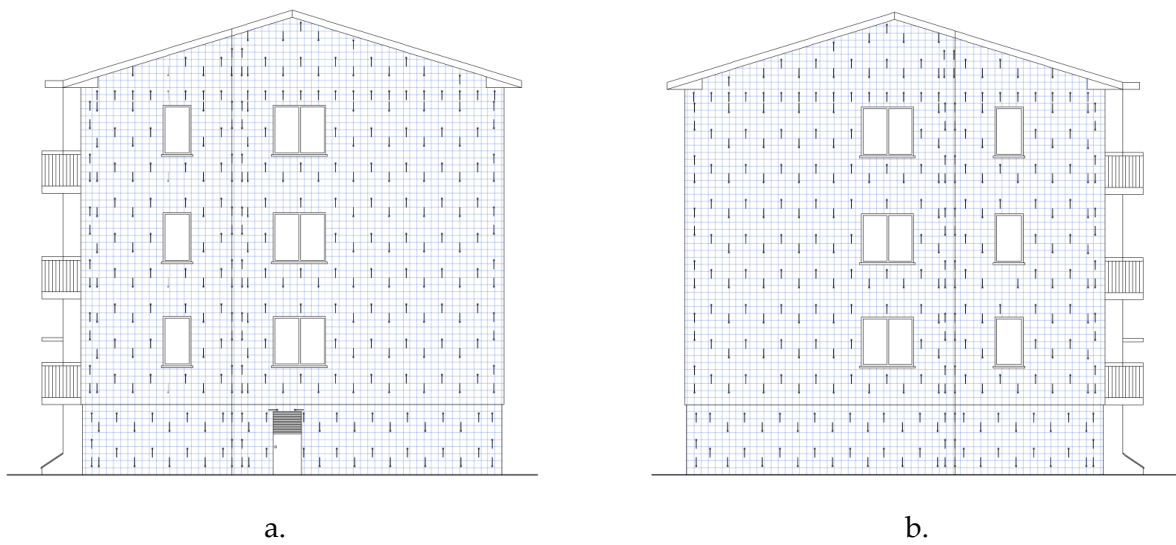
Intonaco armato con rete elettrosaldata su due lati: a) prospetto nord; b) prospetto sud.
